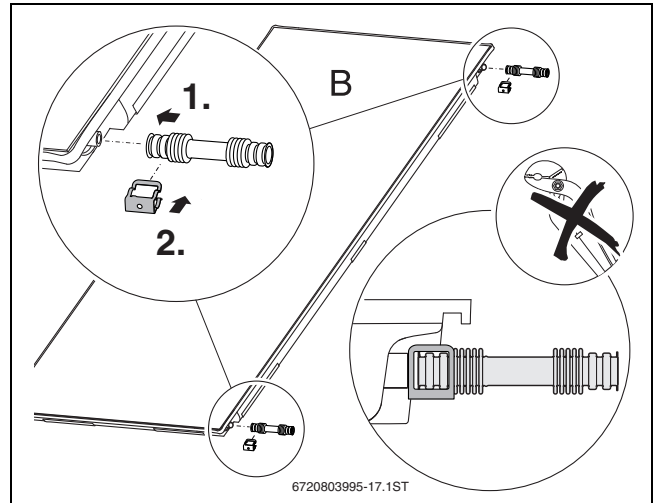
Montage du kit de raccordement sur le deuxième capteur et tous les autres
